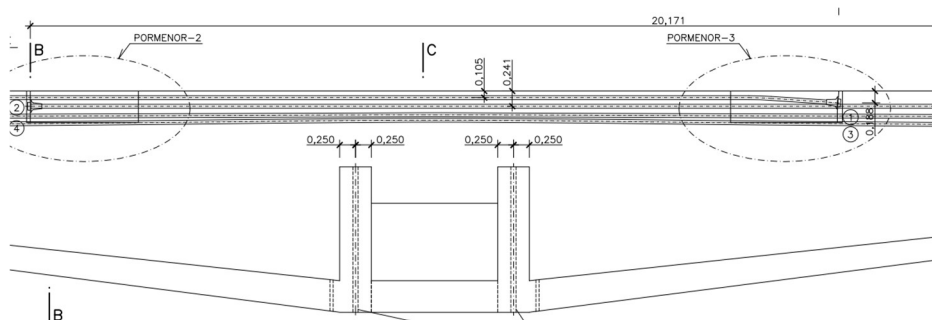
Interior da viga martelo com o traçado longitudinal dos cabos de pré-esforço C1 à C4
